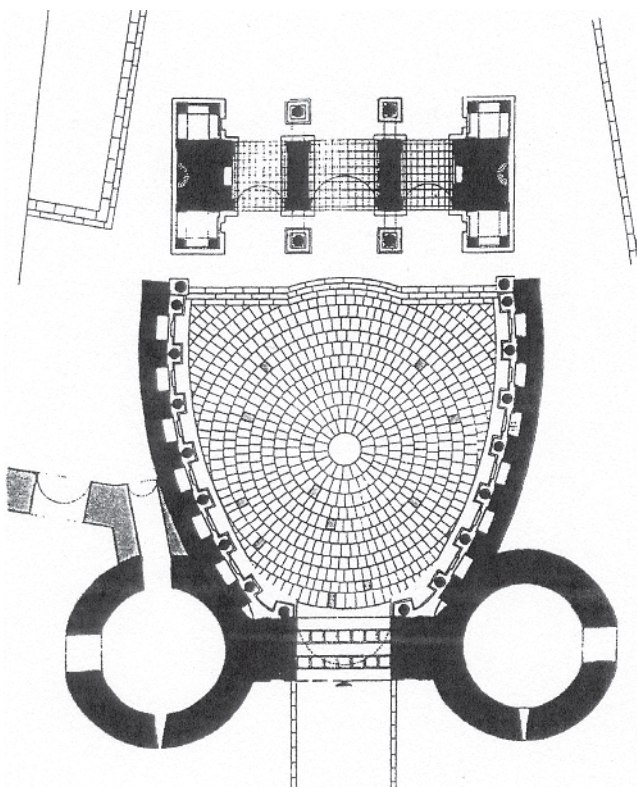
Perge, Grundriss des von Plancia Magna am Südtor errichteten Bauensembles
